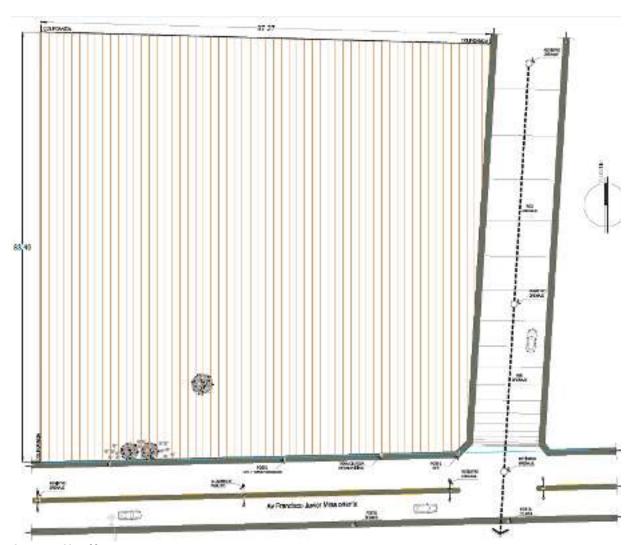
Plano de localizacion de servicios red de agua potable, drenaje, alumbrado público y telefonía. Fuente: plano elaborado por Juan Martínez
